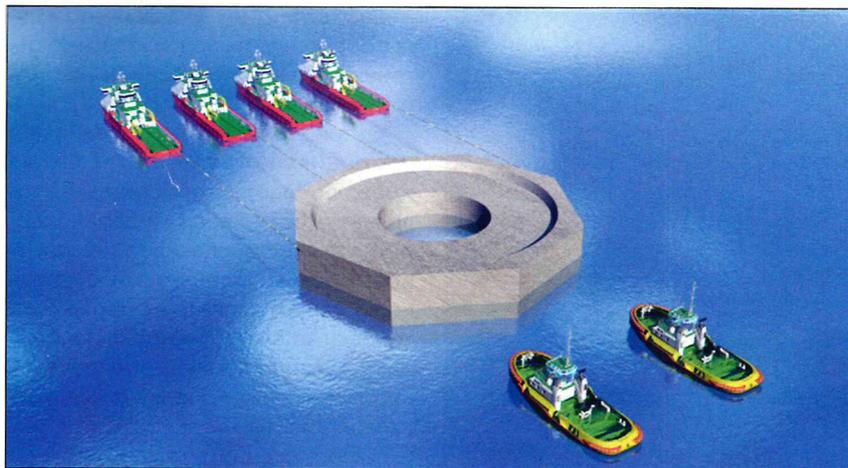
Транспортировка и установка на грунт железобетонной подставки
